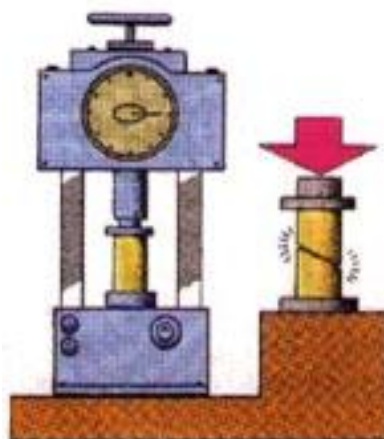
Esquema de ensayo de rotura por compresión.
